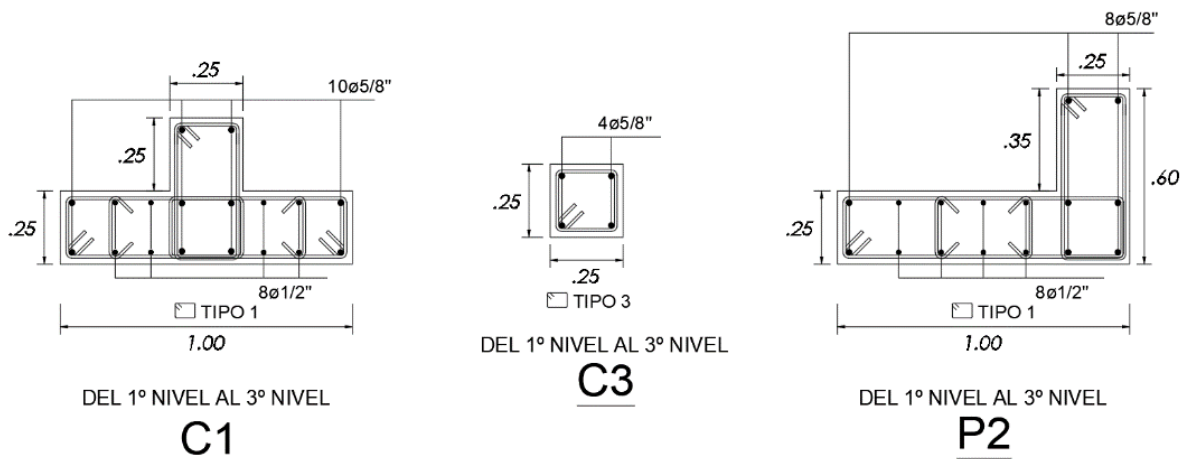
Detalle de columnas existentes, bloque 2 del pabellón A - I.E. N°40092
